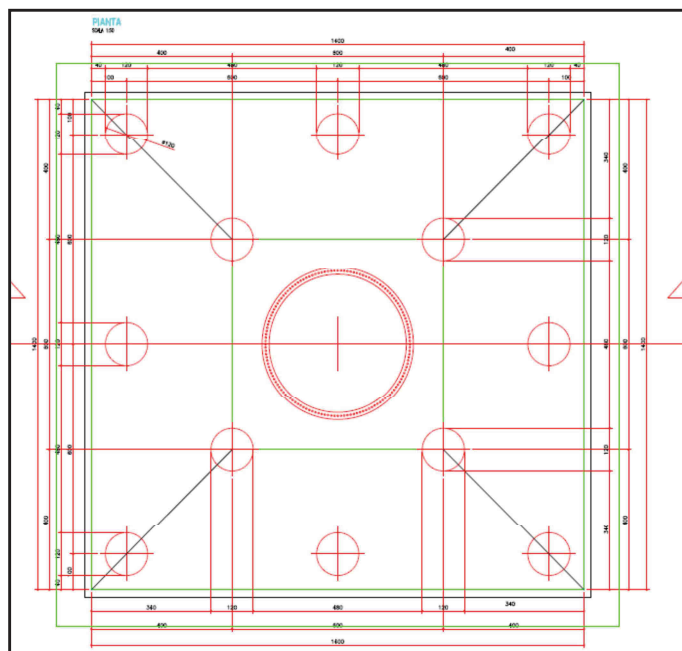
Schema della pianta di fondazione dell'aerogeneratore.
